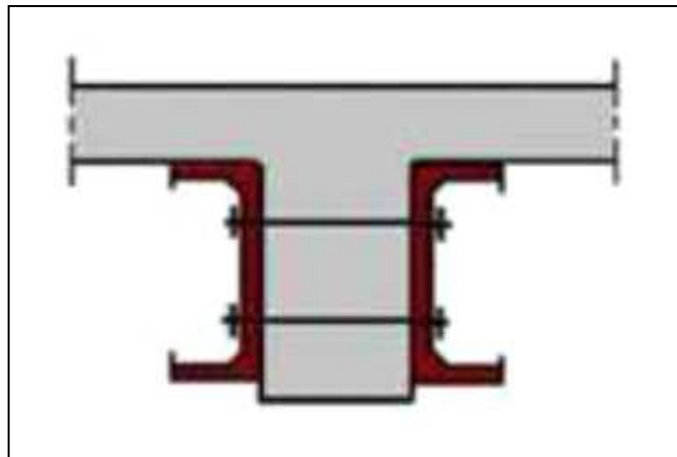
Renforcement d'une poutre en béton armé avec profils métalliques [19]
